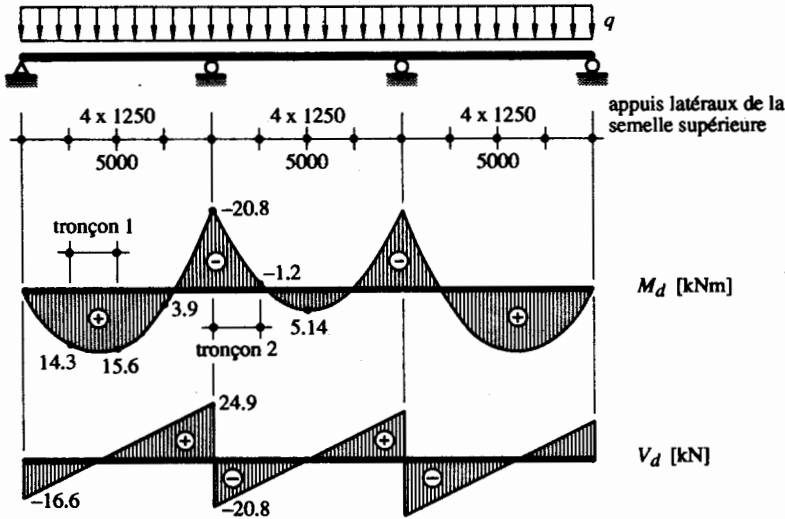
Poutre continue constituée d'un profilé laminé en double té.
